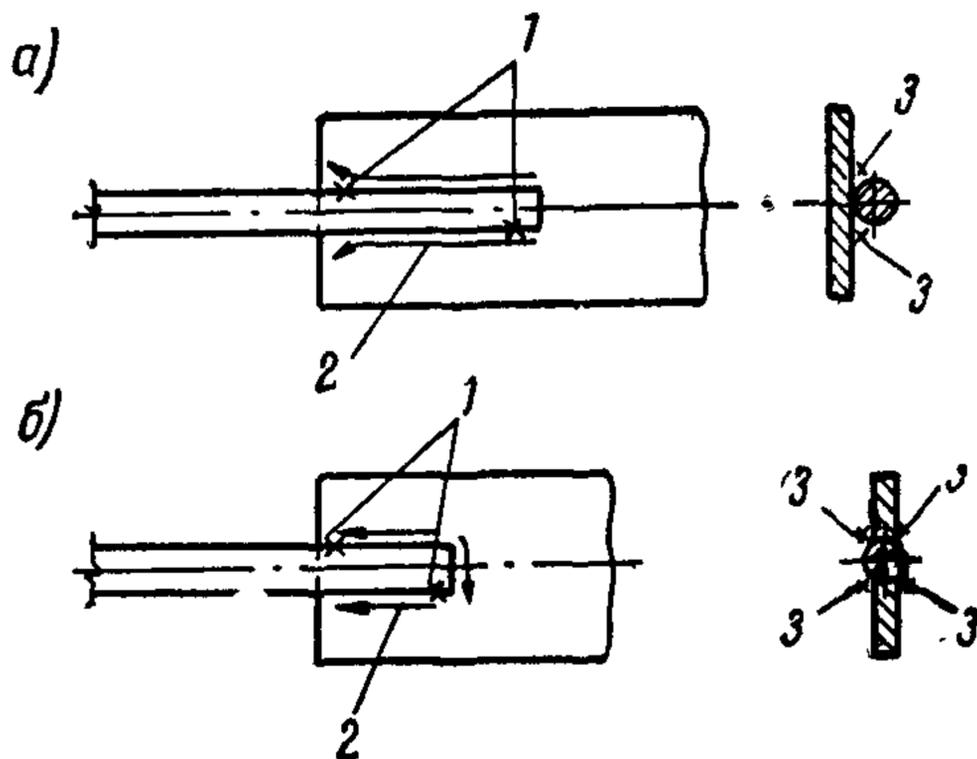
Размеры сварных фланговых швов при соединении арматурных стержней с плоскими элементами закладных деталей
